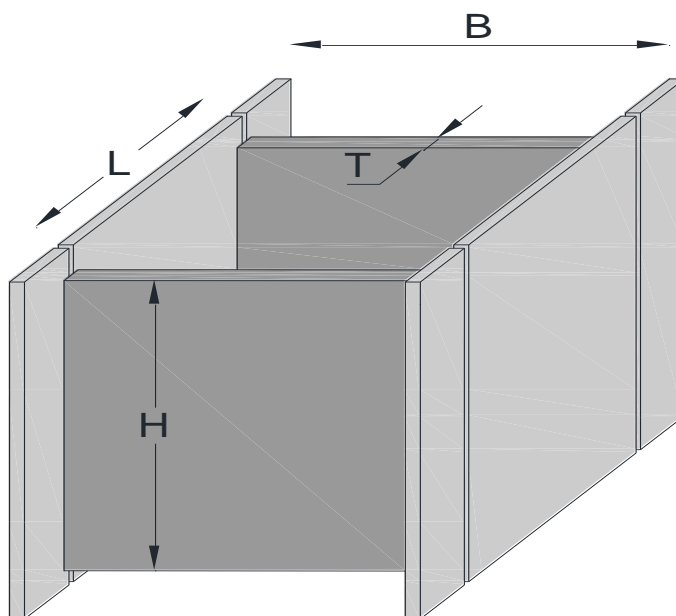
Escavação com a solução de painéis longitudinais de CSM.
